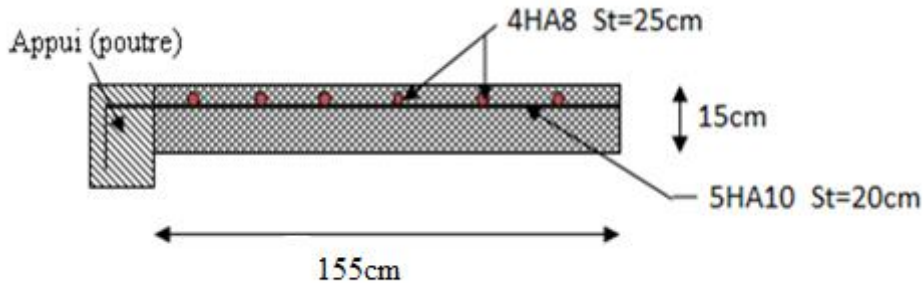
schéma de ferrailage de la dalle sur une seule appuis.
